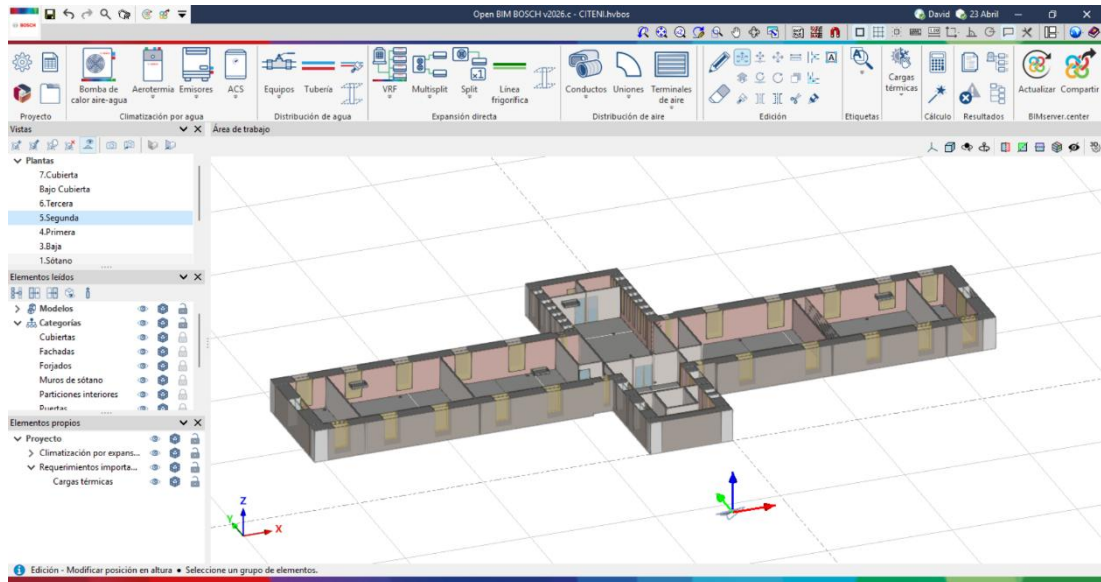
Disposición en planta de unidades interiores. Fuente: Open BIM BOSCH.
